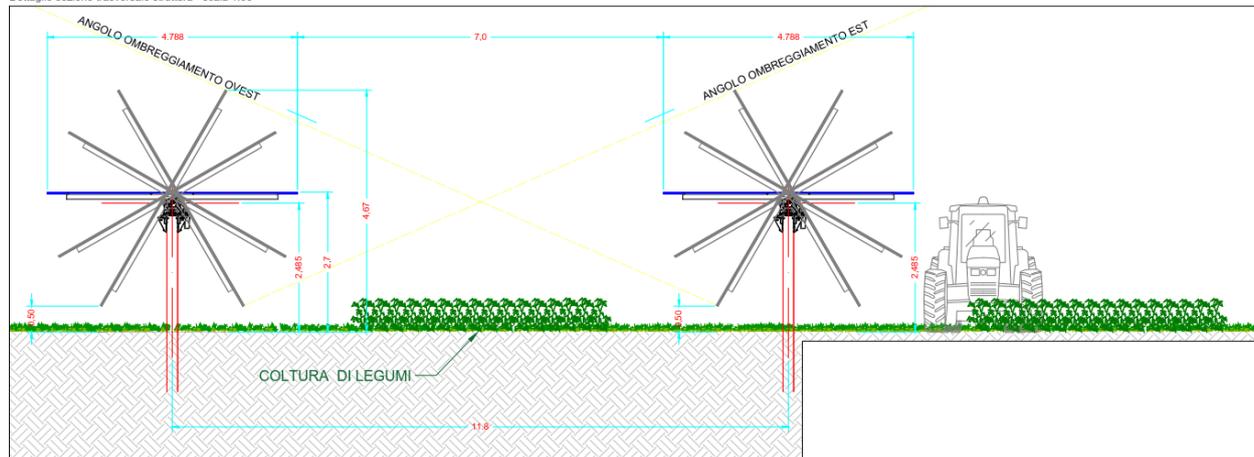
Particolare disposizione strutture di sostegno e spazio tra le file
